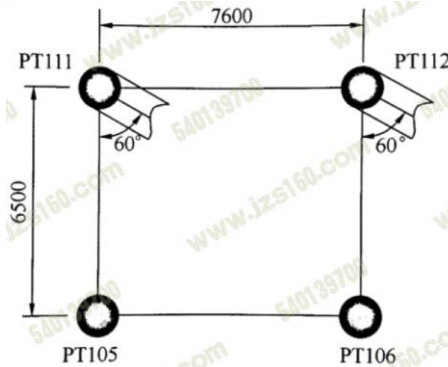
工作平台底面局部桩位平面示意图 (图中单位: 尺寸为 mm)
